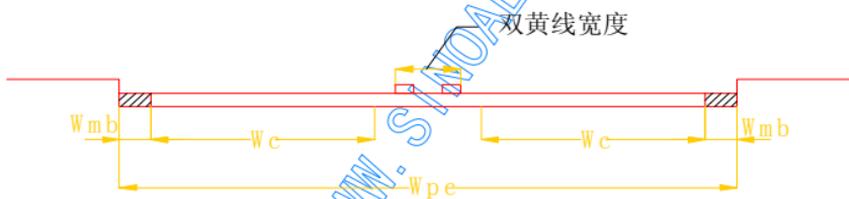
单幅路、三幅路路面中间画双黄线时横断面布置图
